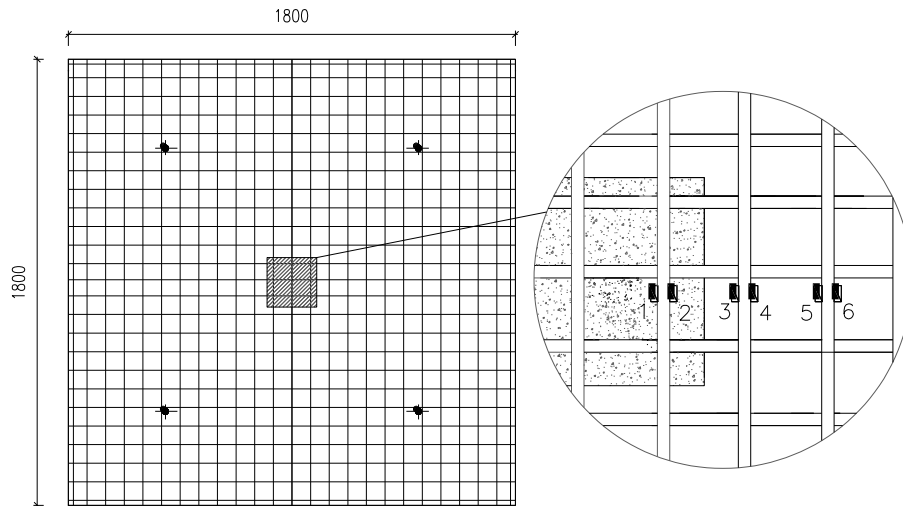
Localização dos extensómetros colados à armadura longitudinal superior (Direcção “E-O”).
